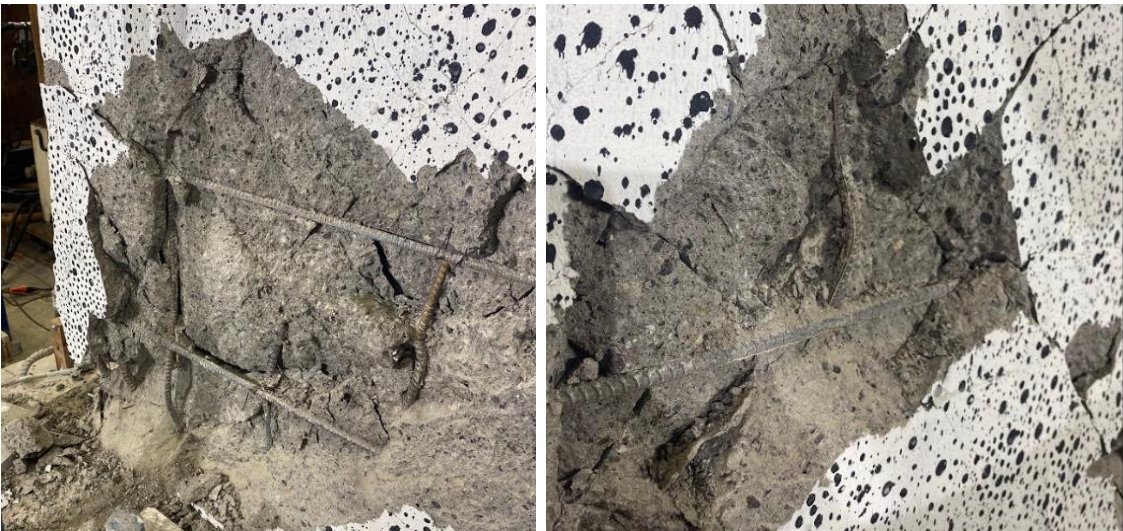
Pandeo de Barras Verticales del Alma, Vista Lado norte
